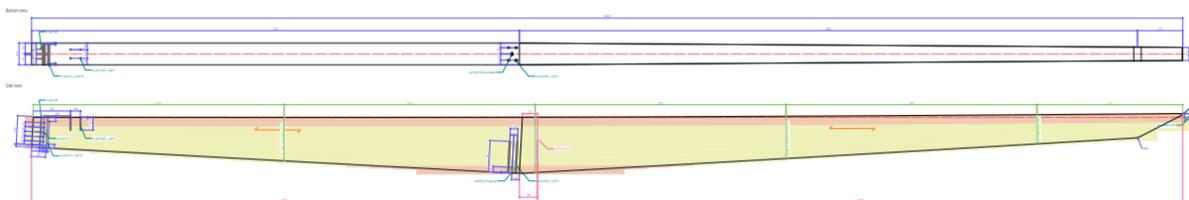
Grundriss und Ansicht eines BSH-Trägers, © HESS TIMBER
